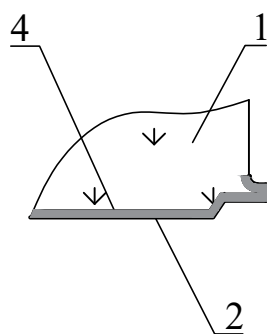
Кровельная сэндвич-панель с теплоизоляционным слоем из плит DoorHan с металлической облицовкой
